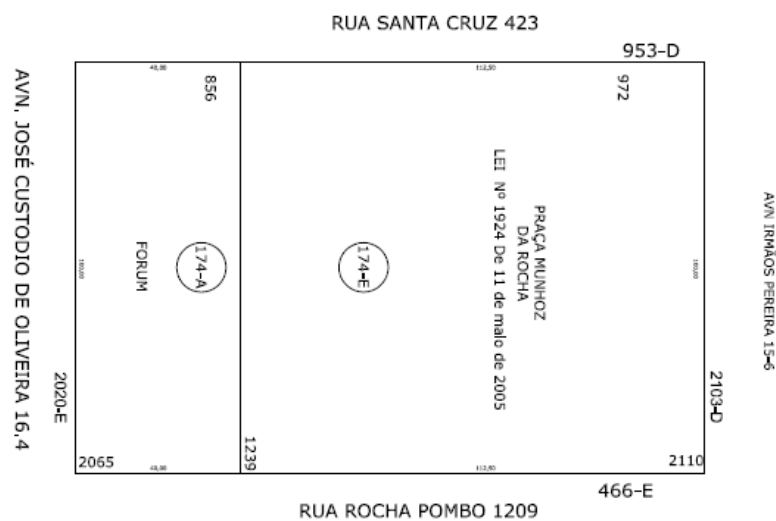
Planta de Localização da Praça Bento Munhoz da Rocha Netto.
